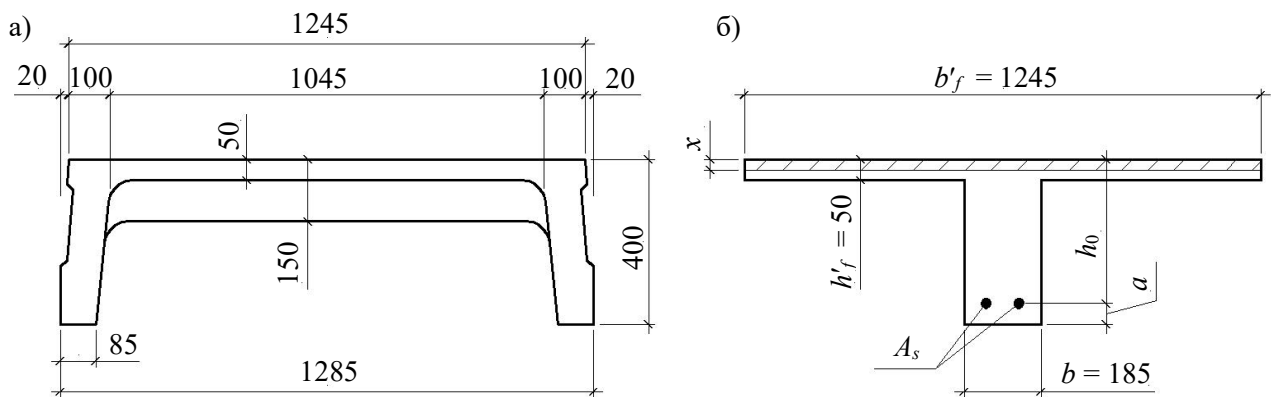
К расчету продольного ребра ребристой плиты перекрытия: а) заданное поперечное сечение плиты перекрытия; б) расчетное поперечное сечение плиты перекрытия
